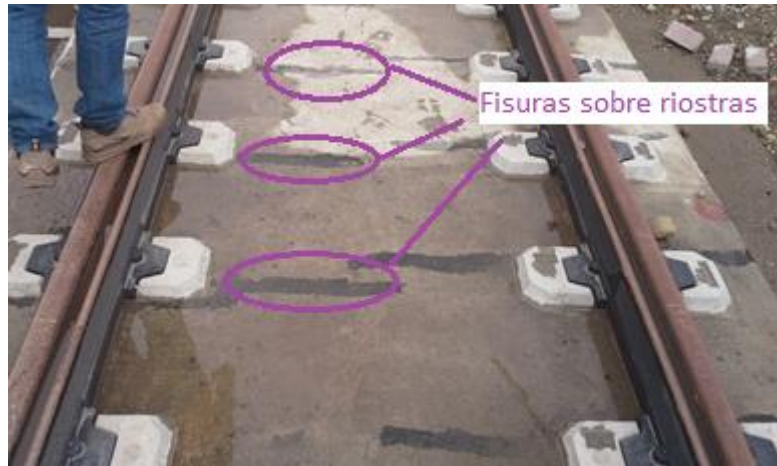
Fisuras ocasionadas sobre los separadores de durmientes
